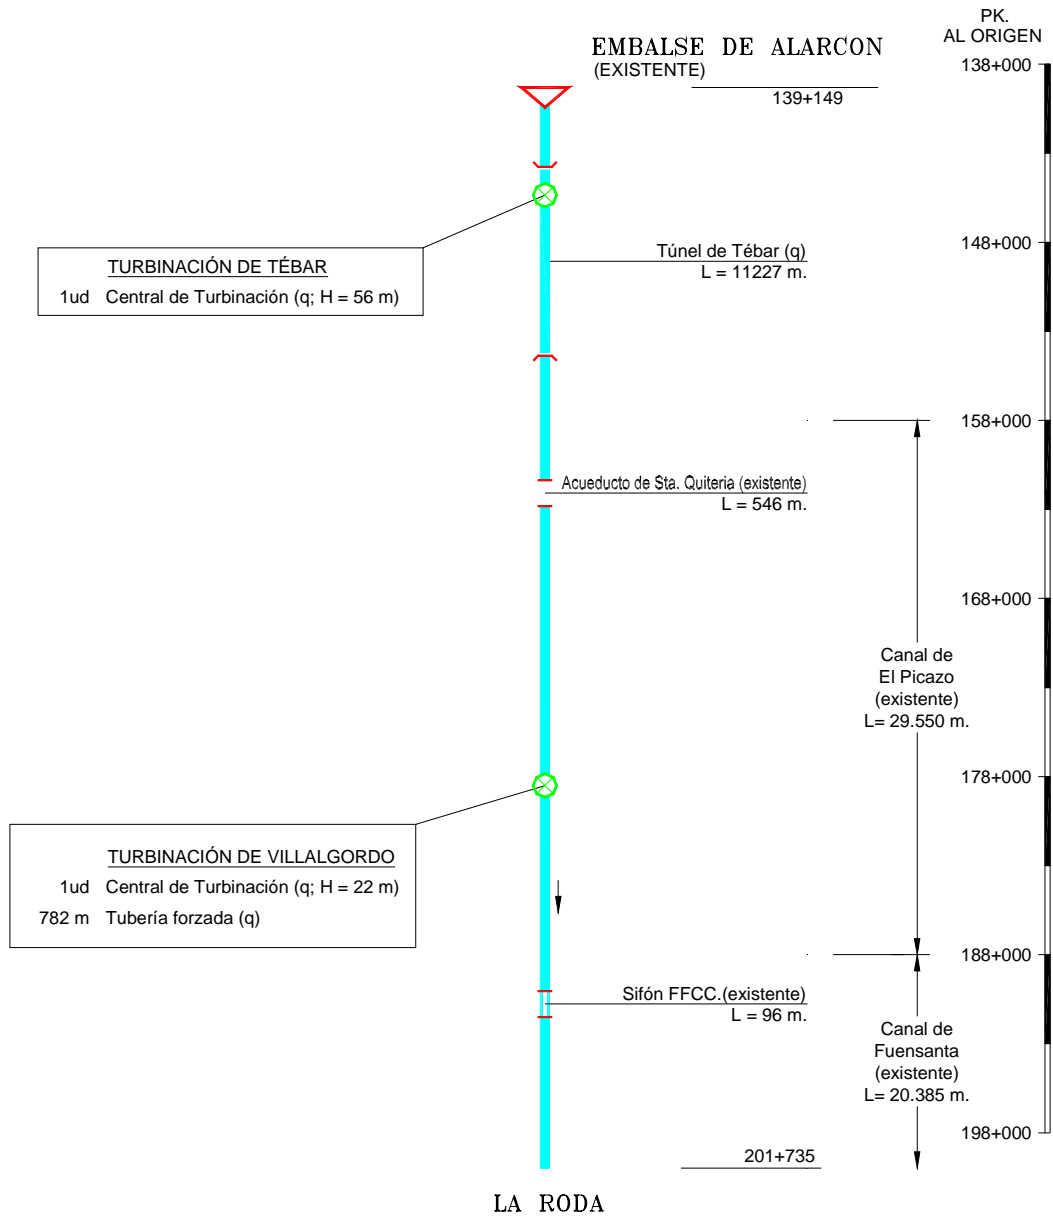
Conducción Alarcón-La Roda. Esquema en planta
